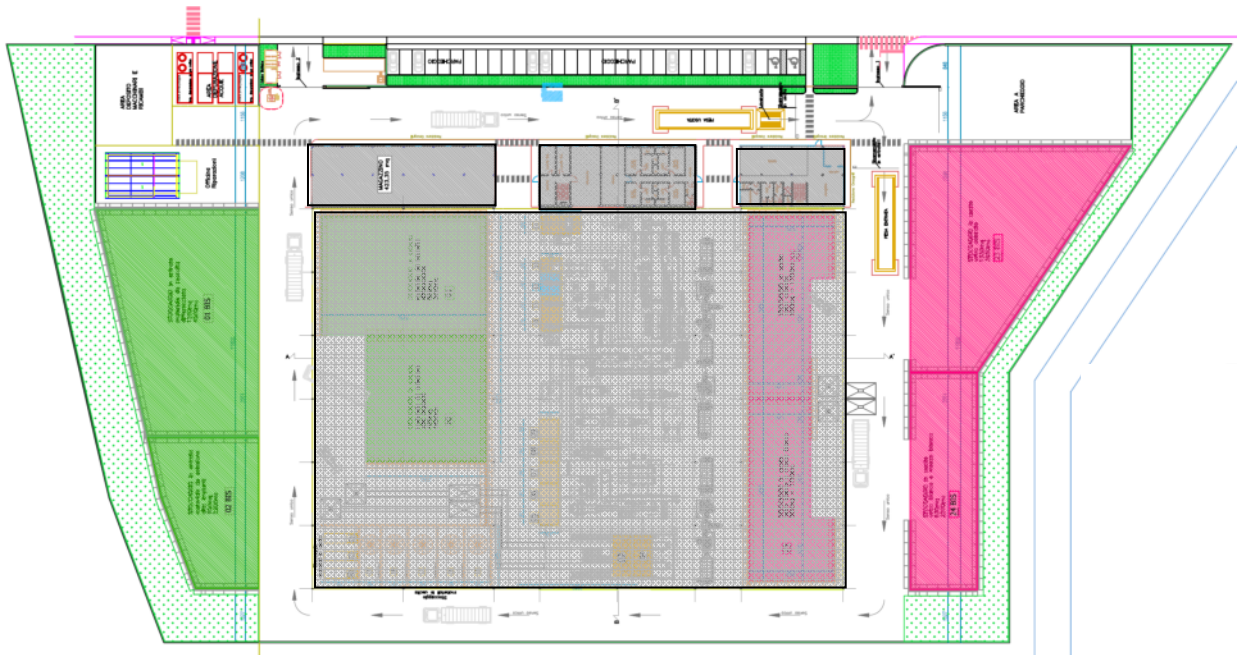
planimetria progetto trattamento rifiuti vetrosi assentito - 2014
